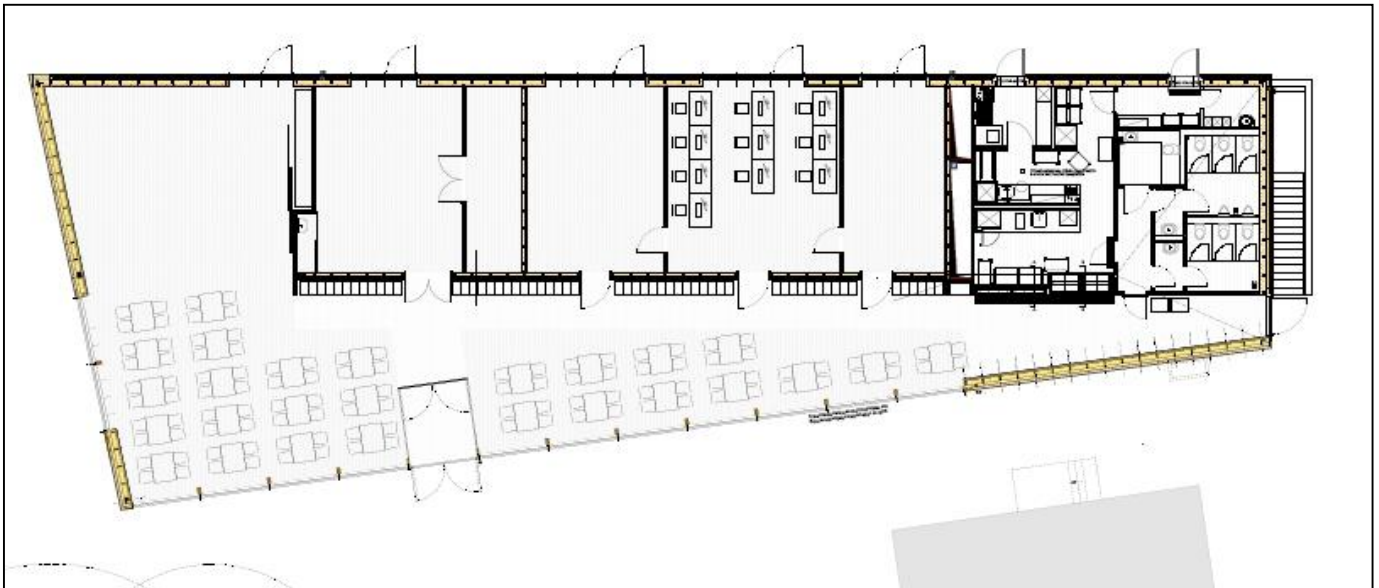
Grundriss Erdgeschoss Ganztagesbetreuung Neues Gymnasium Nürnberg (Quelle: Sander-Architekten Nürnberg)
